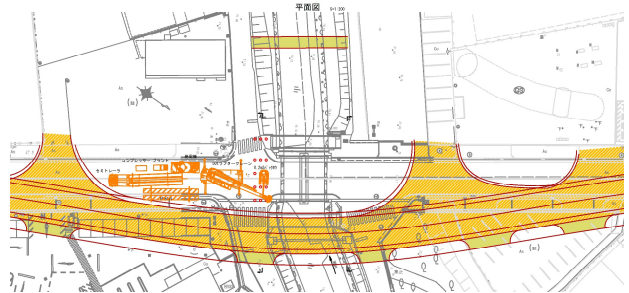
施工ステップ平面図（基礎工構築 A1 橋台時）
